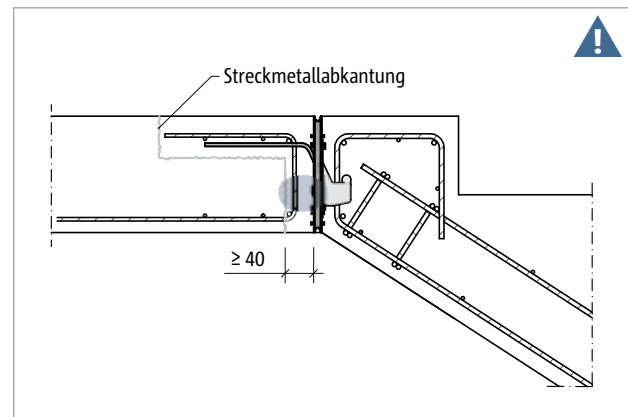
Schöck Tronsole® Typ T: Einbau in Verbindung mit Arbeitsfugen am Deckenrand, Druckfuge deckenseitig
